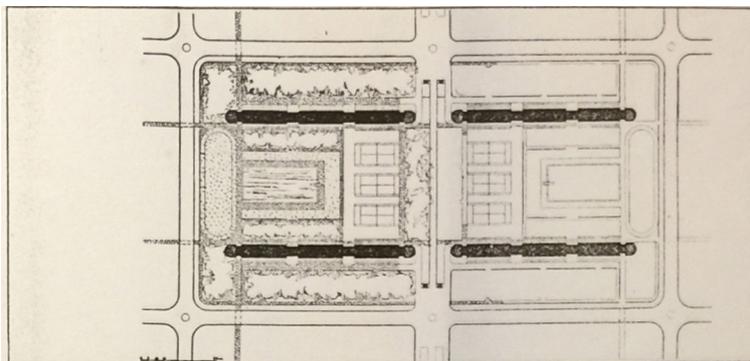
Le Corbusier - Maqueta de la ville Radieuse
